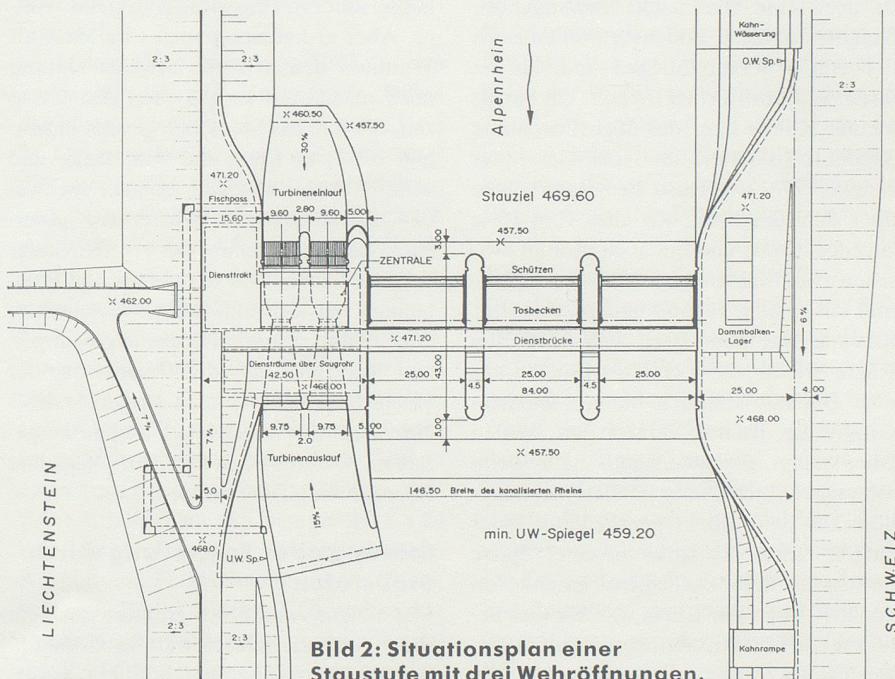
Situationsplan einer Staustufe mit drei Wehröffnungen.
